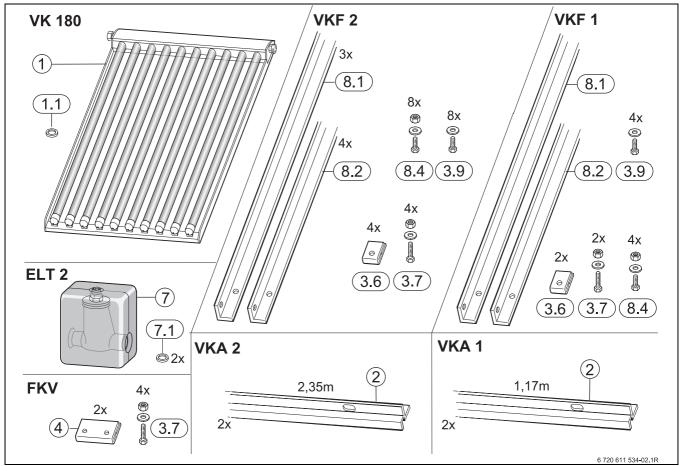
VK 180 mit Montage-Zubehören Flachdach
